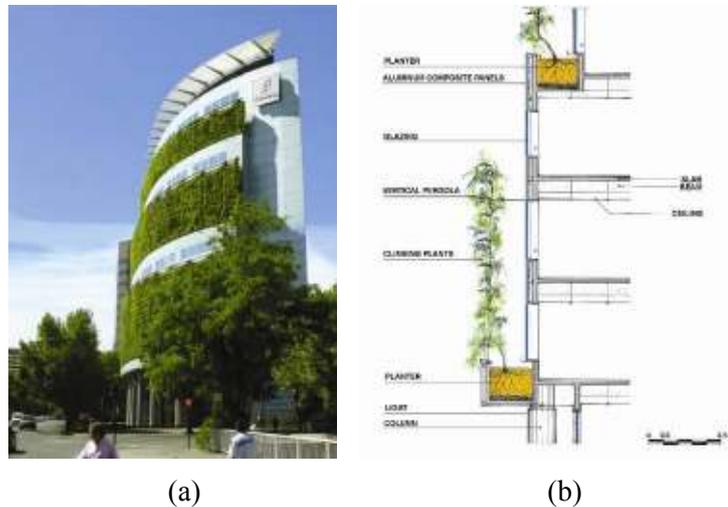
Pele-verde do edifício Consórcio – vista externa (a) e detalhe em corte da treliça com vegetação (b) (fonte: BROWNE, 2007).
